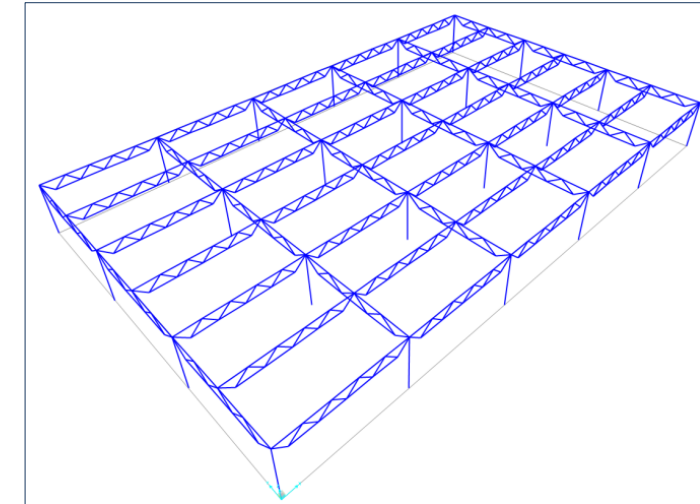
a. Modelado de la estructura metálica en SAP. Sala de ventas
